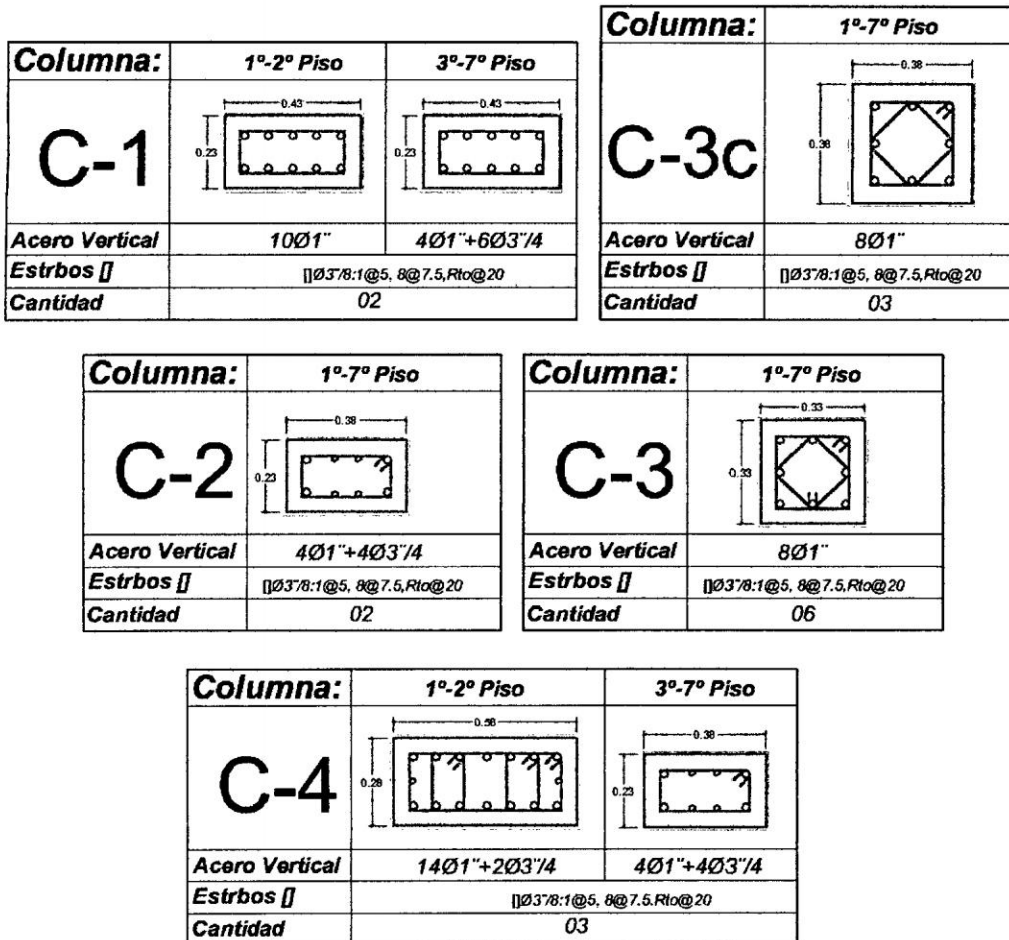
sección final de las columnas que cumple con la revisión de columna fuerte viga débil
